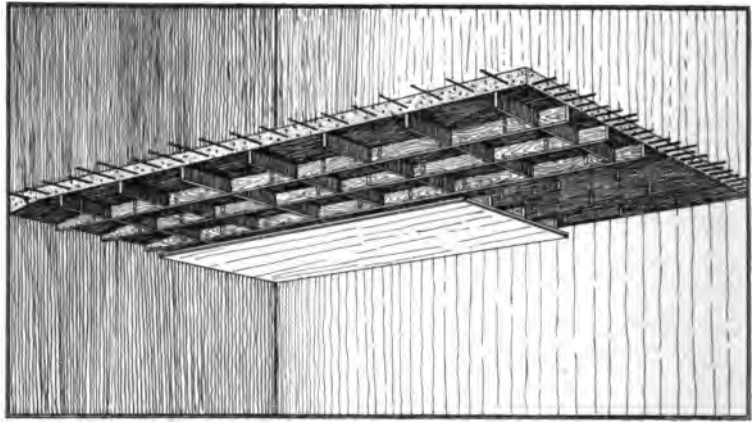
Holzunterkonstruktion an Eisenbetondecken von S. Zipkes.
